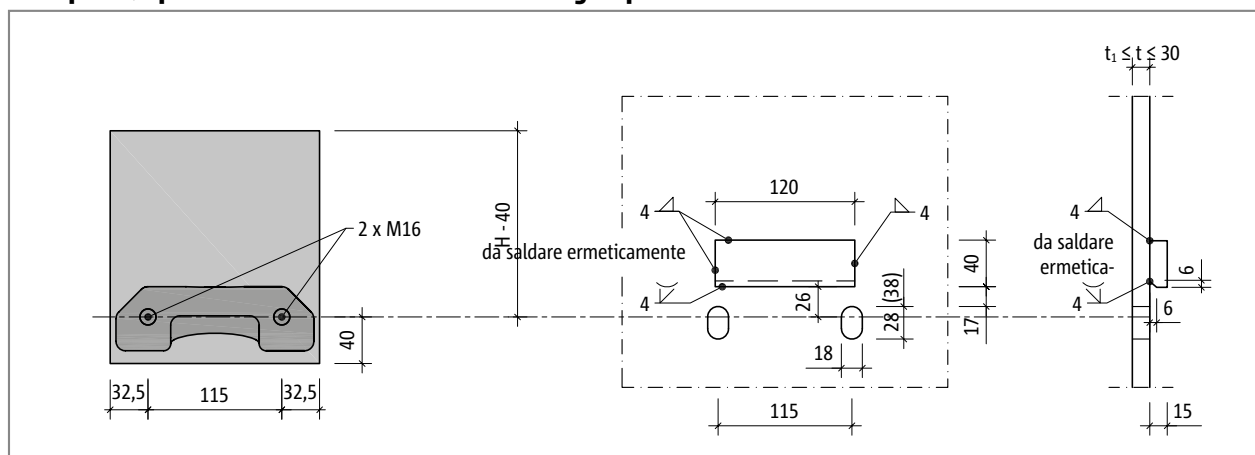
Schöck Isokorb® T tipo SQP: costruzione del raccordo della piastra di testa
